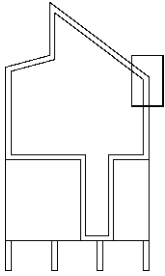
| Detail Decke zu unbeheizt - Wandanschluss. Hand|Werk|Raum. M1:20.
